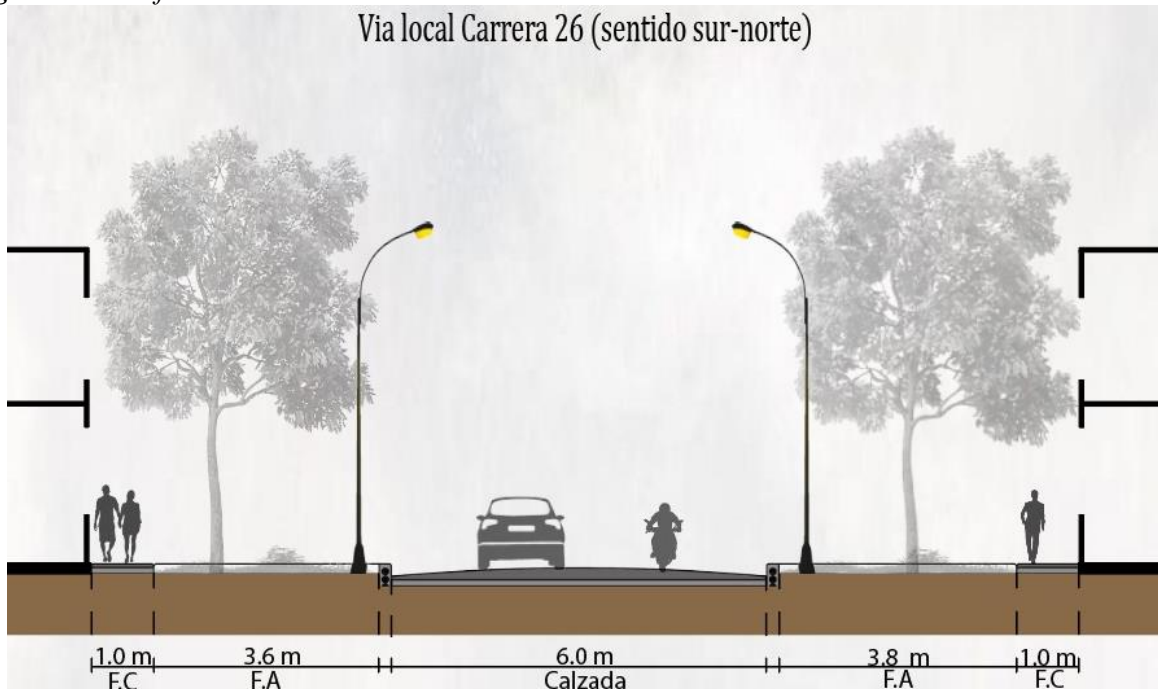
Perfil vial propuesto para la carrera 26 vía local
